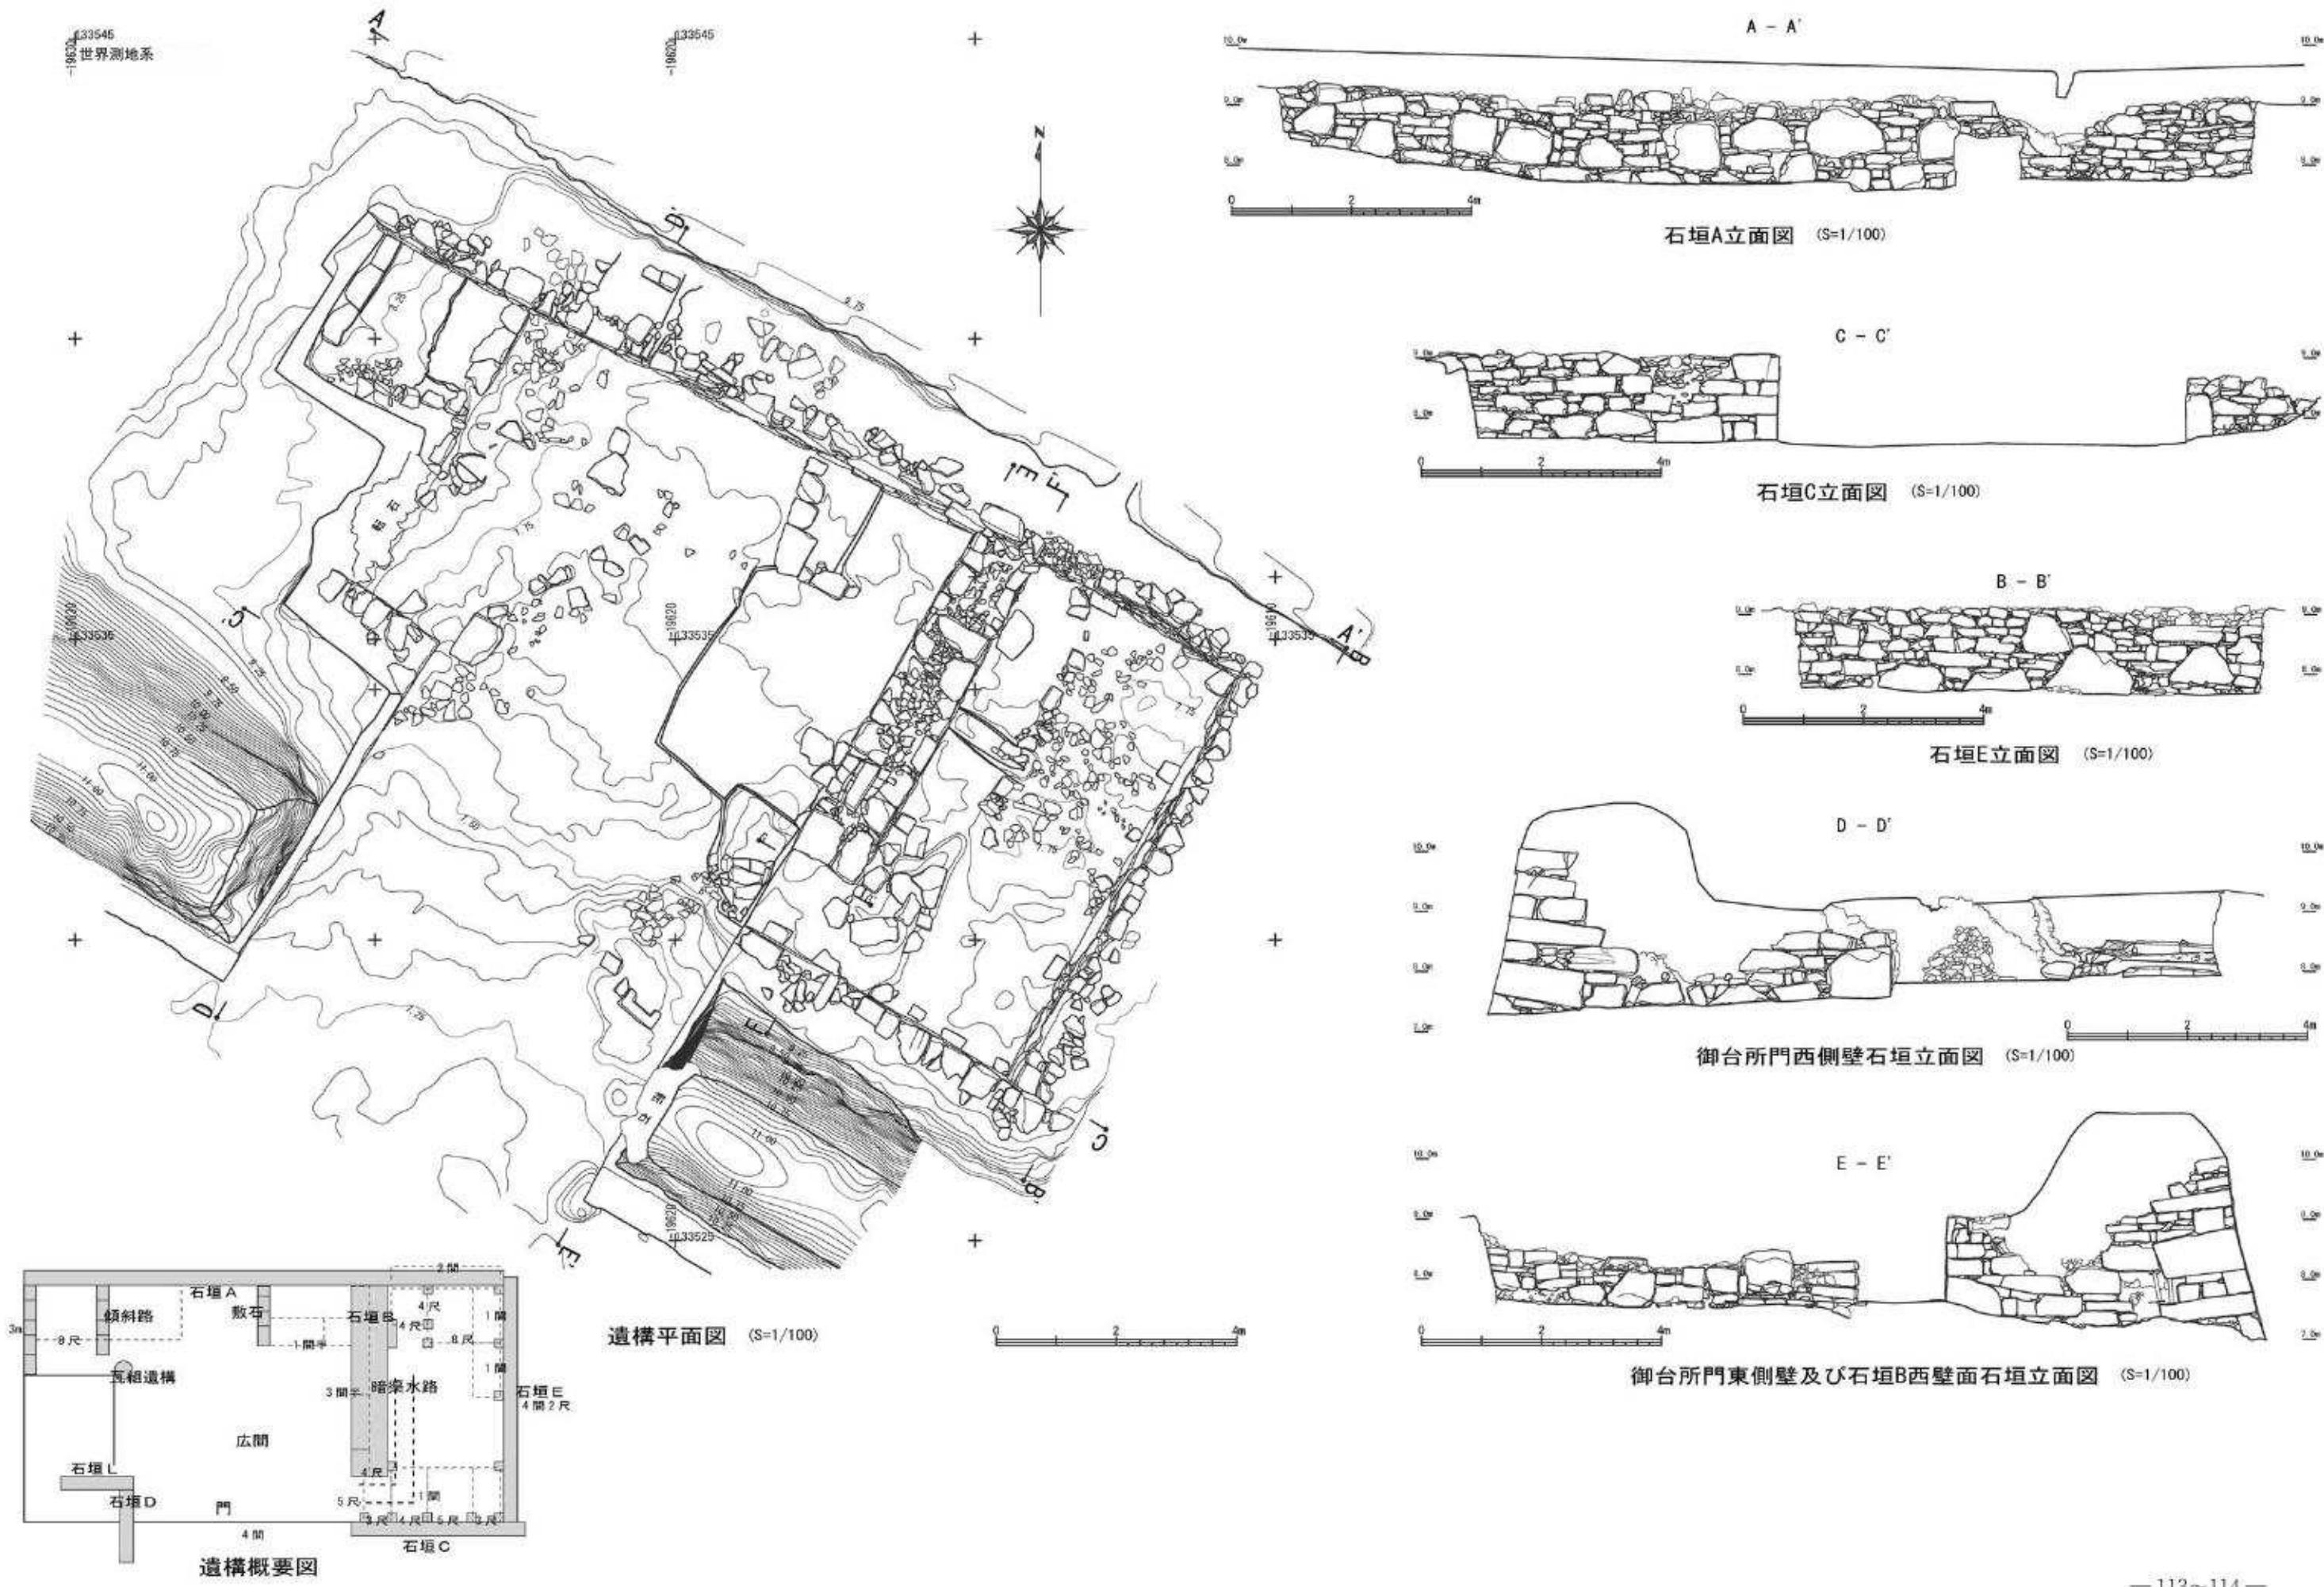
御台所門遺構平面図及び立面図 (S= 1 / 100)
